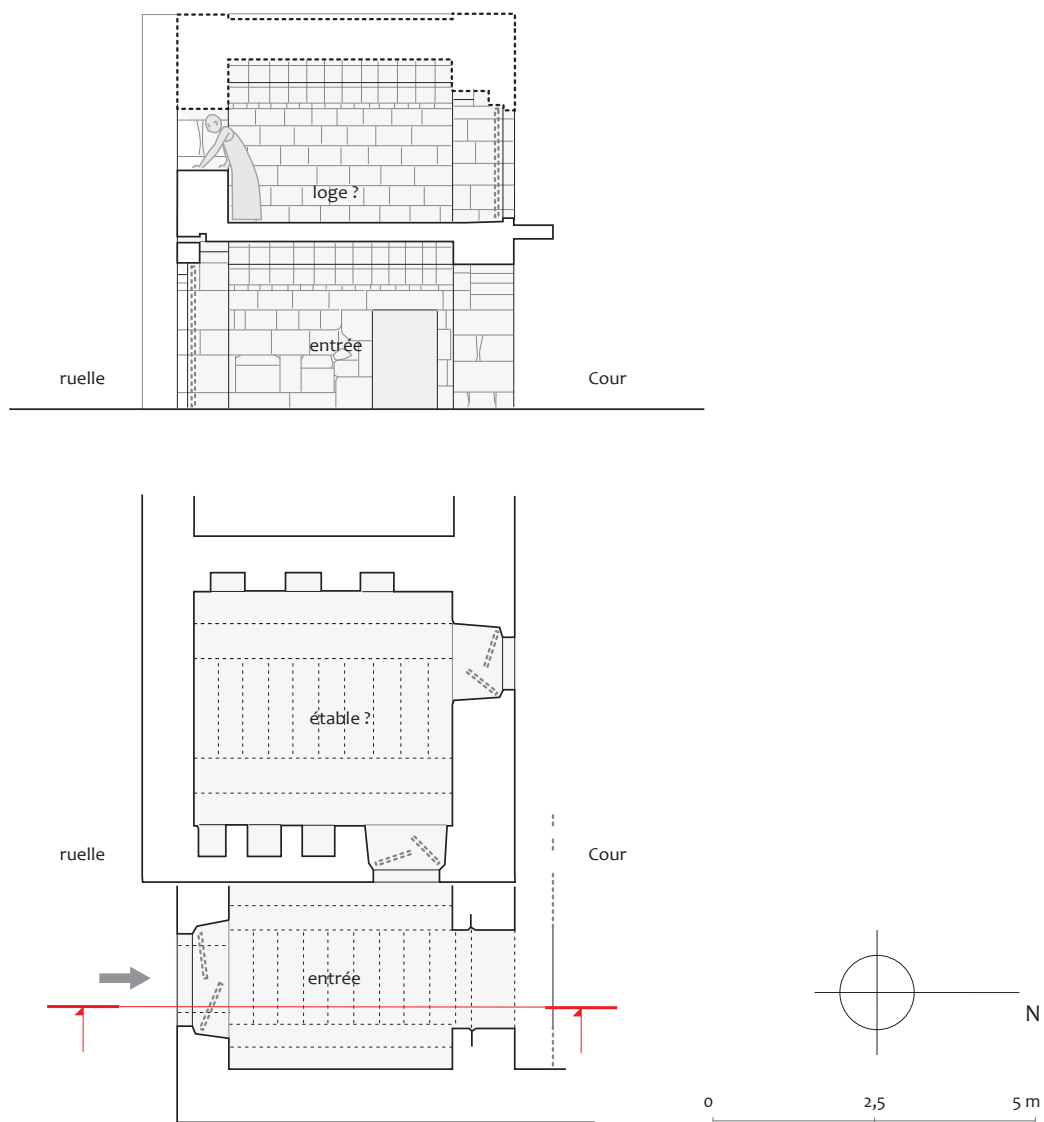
'Umm al-Jimāl, maison XVI. Plan et coupe schématique du porche d'entrée
